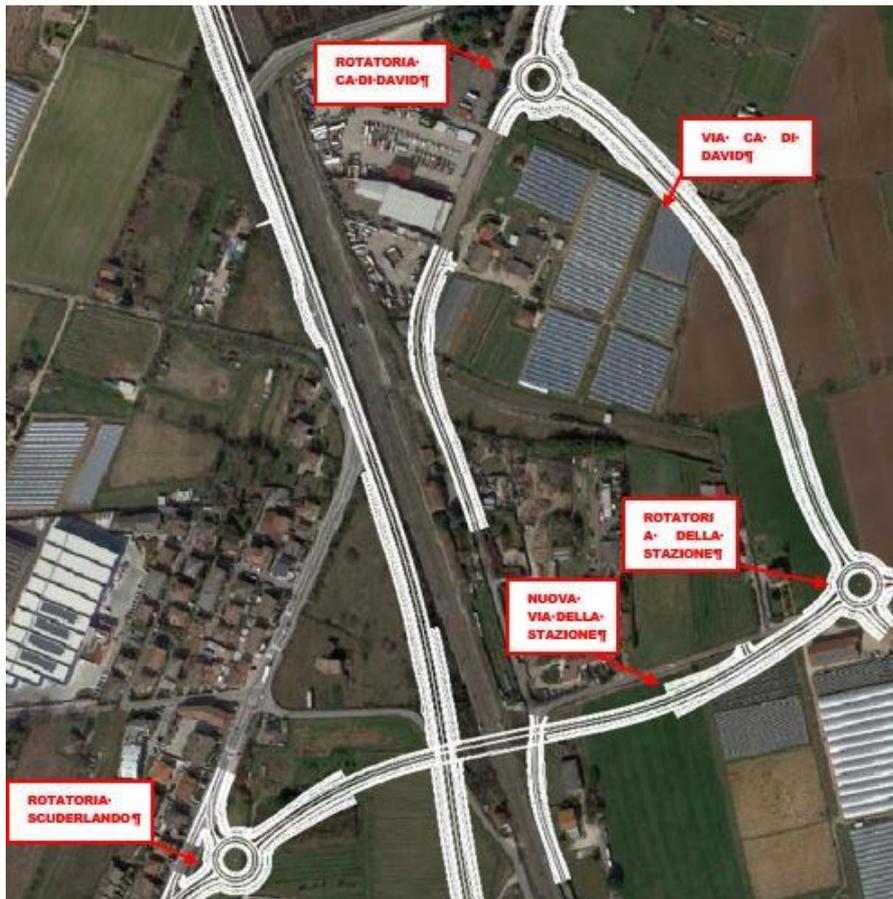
Vista planimetrica della Nuova Via della Stazione
